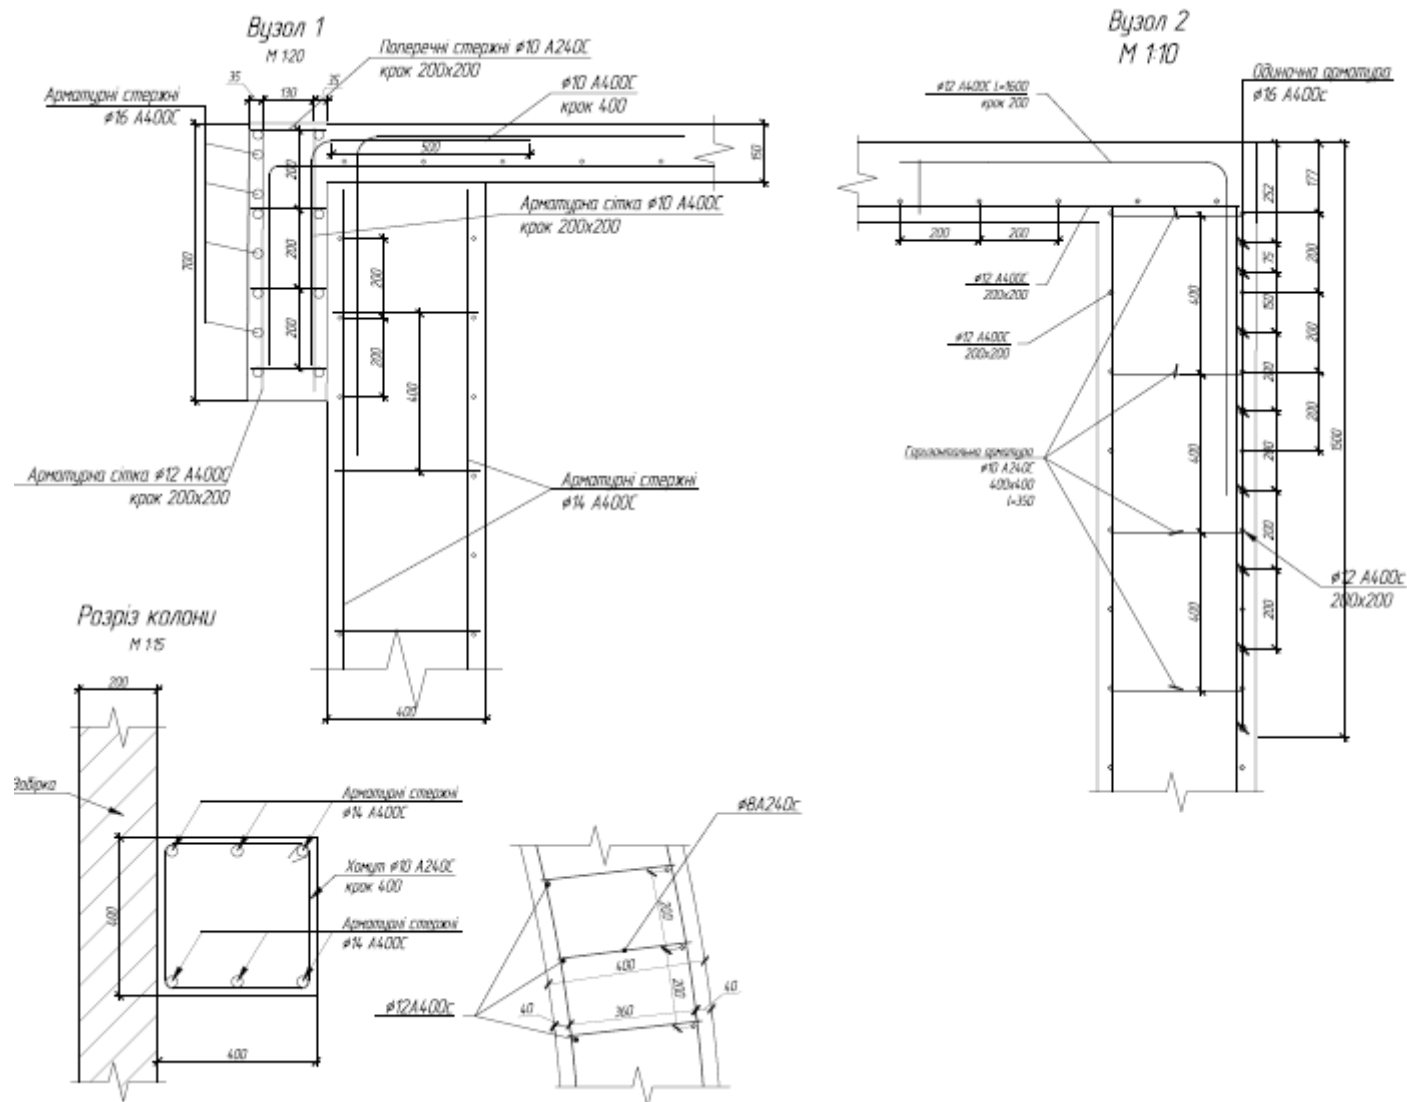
Фрагмент армування монолітного фундаменту хопера
